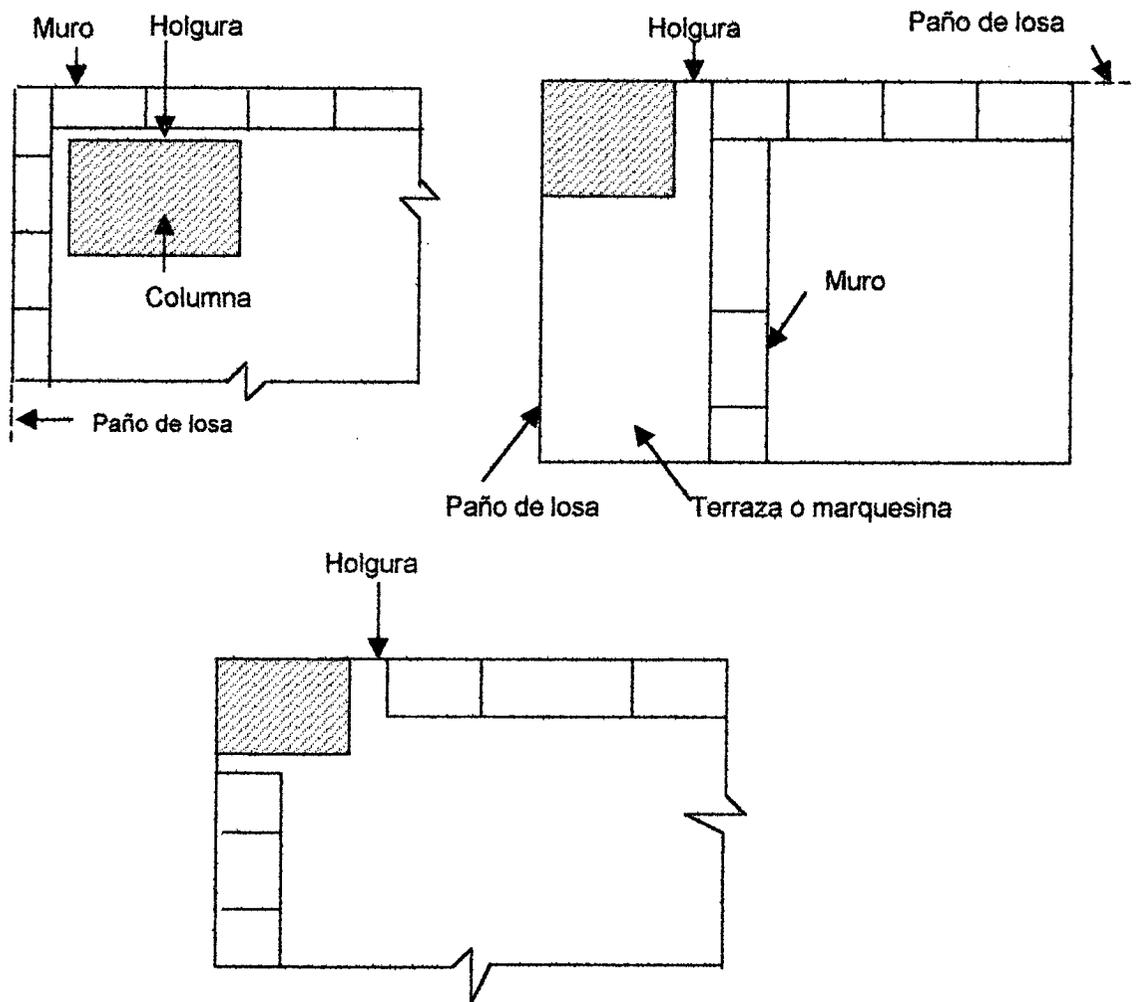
Posibles disposiciones de muros en planta para desligarlos de la estructura.
